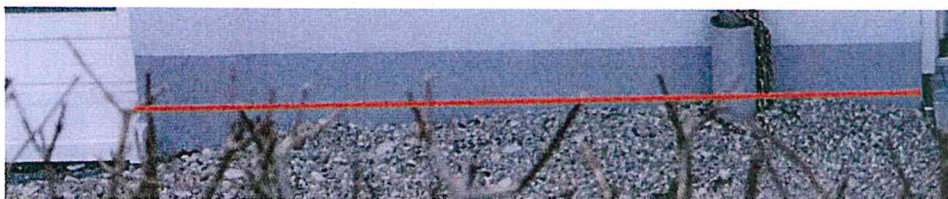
Detail Kiesverlauf Nachbarwohnung
